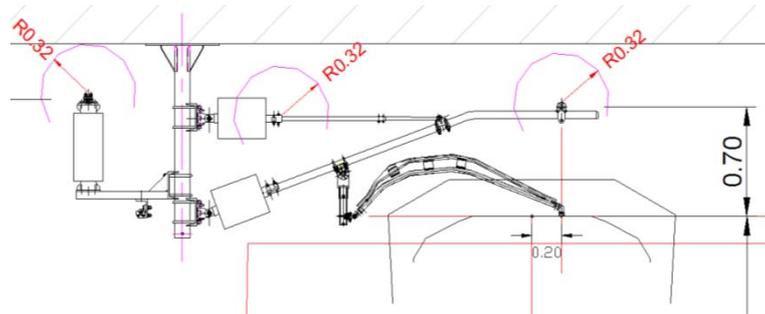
Armamento sotto lavoro opera d'arte speciale con braccio di poligonazione in compressione
